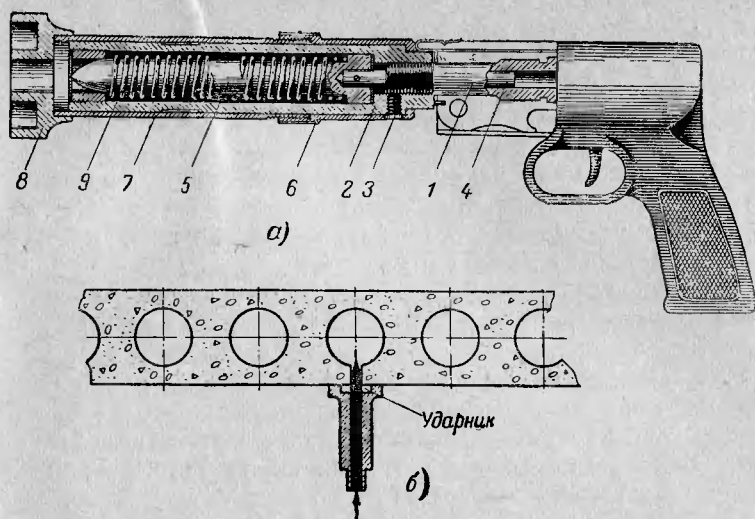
Насадка к пистолету СМП-1 для пробивки отверстий в пустотелых бетонных плитах.
